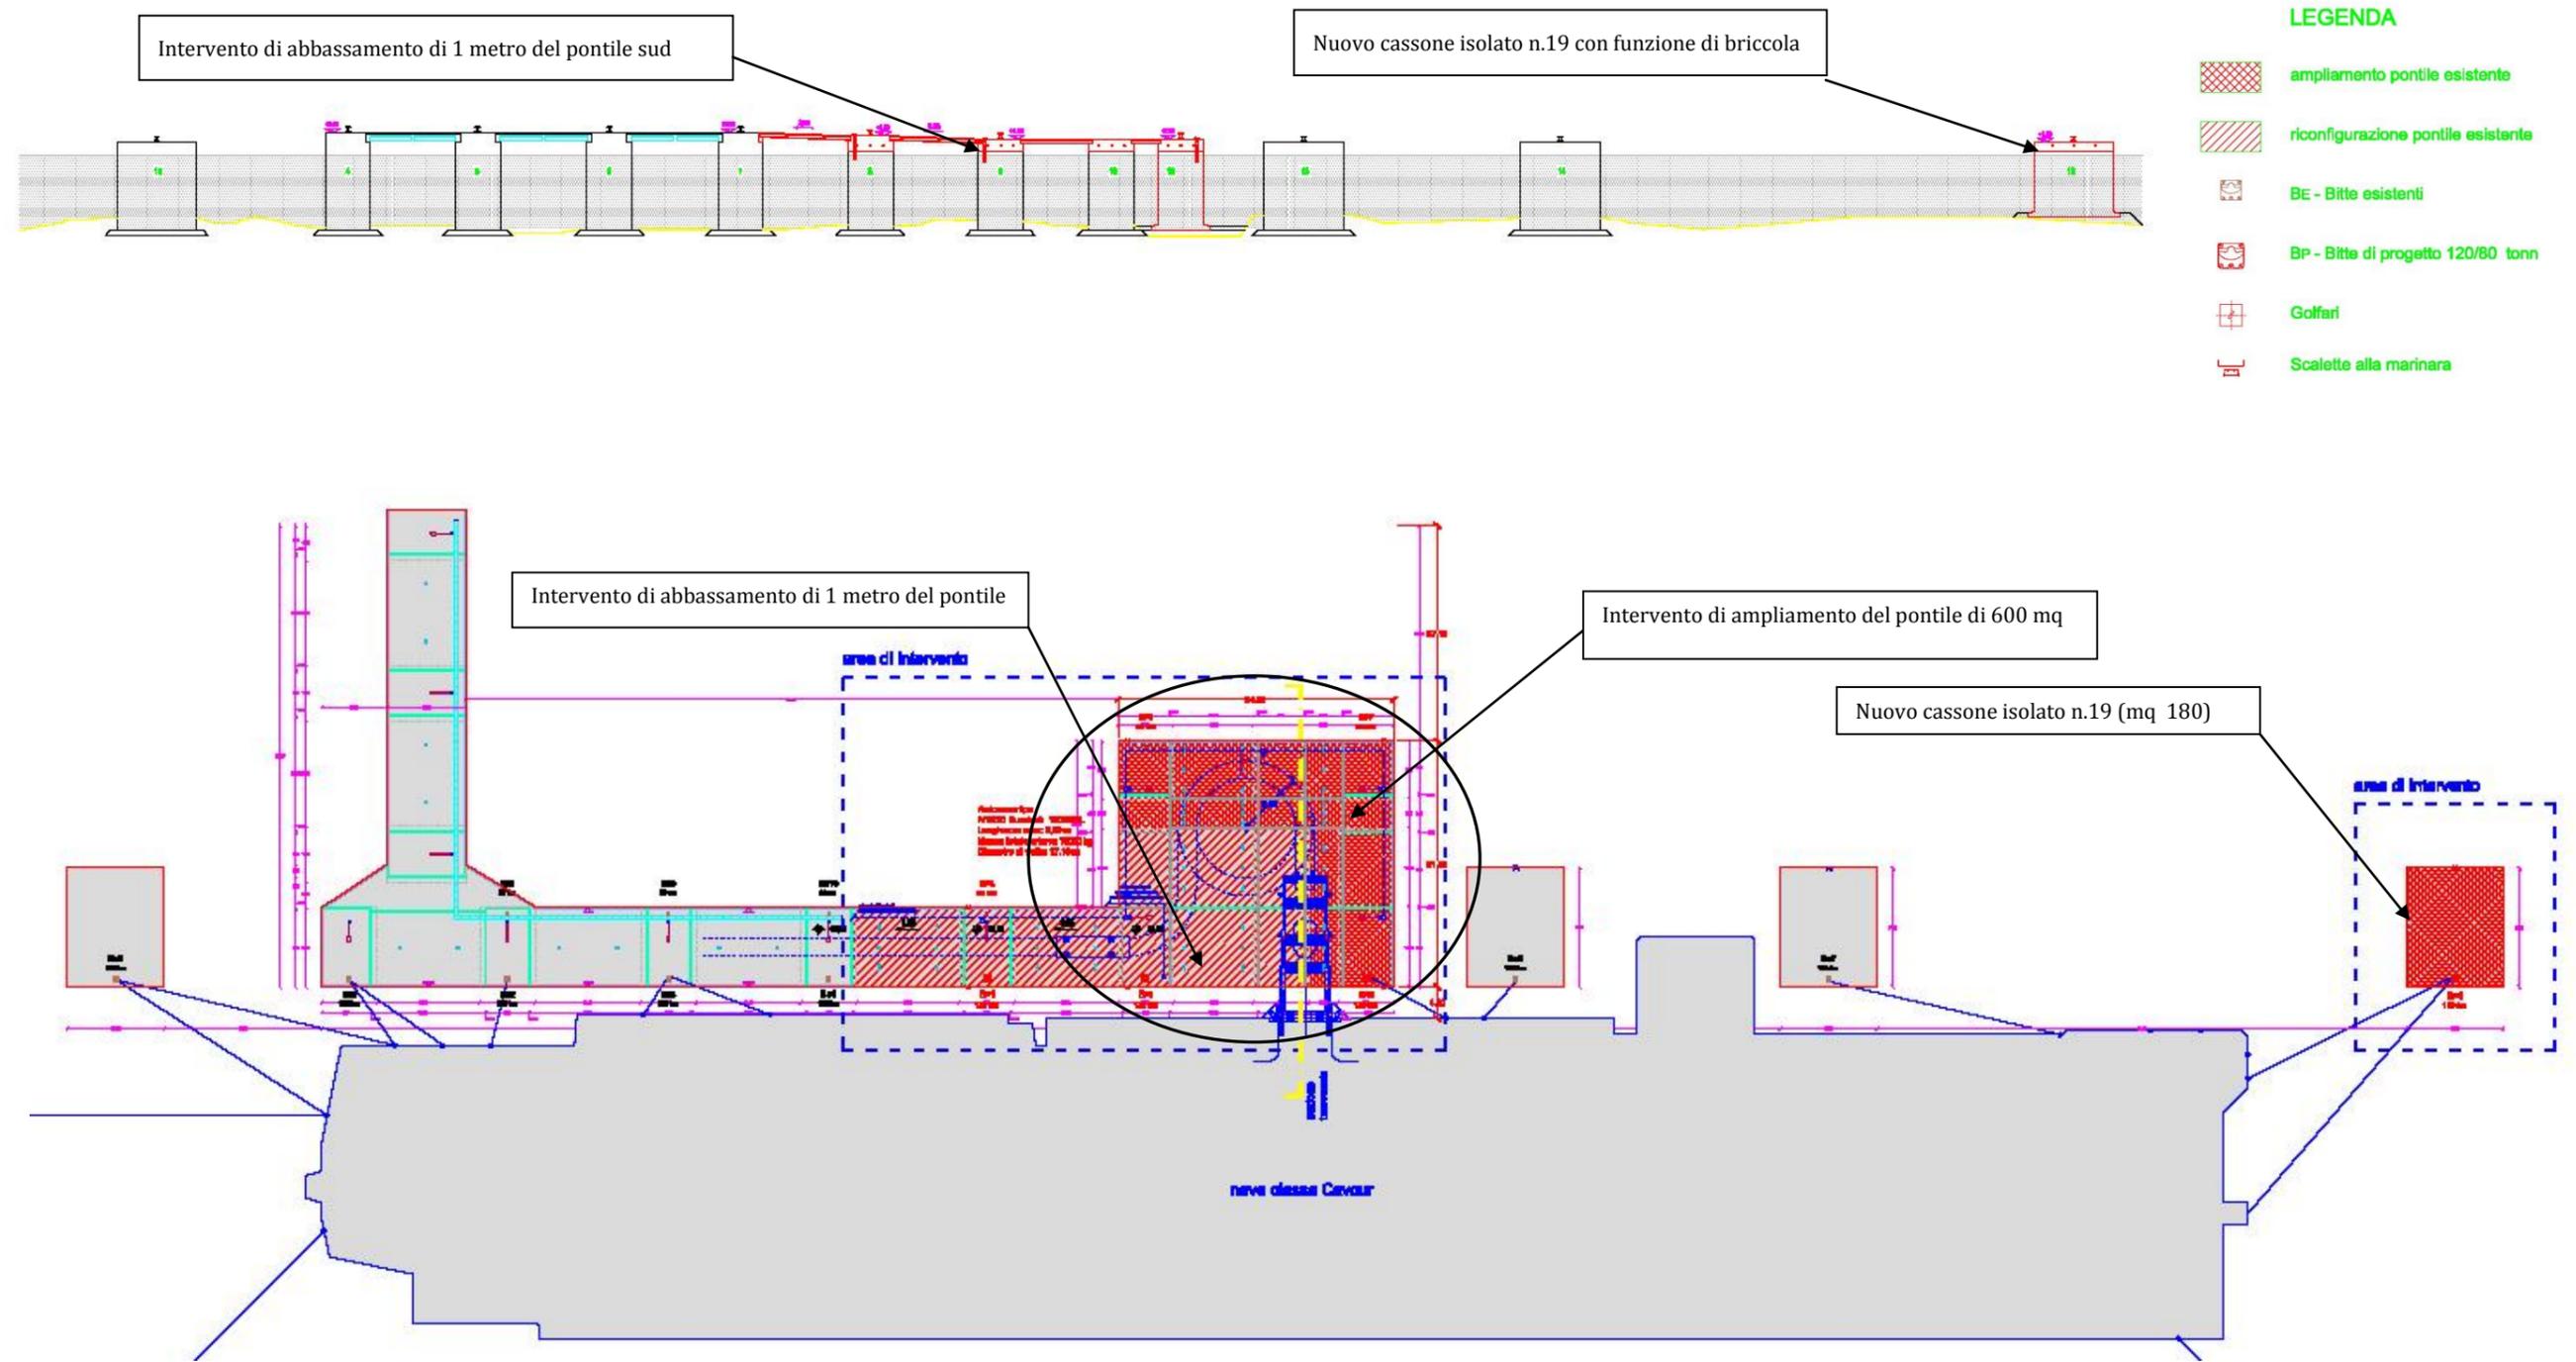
Prospetto e Planimetria intervento di riconfigurazione del pontile sud (non in scala)
